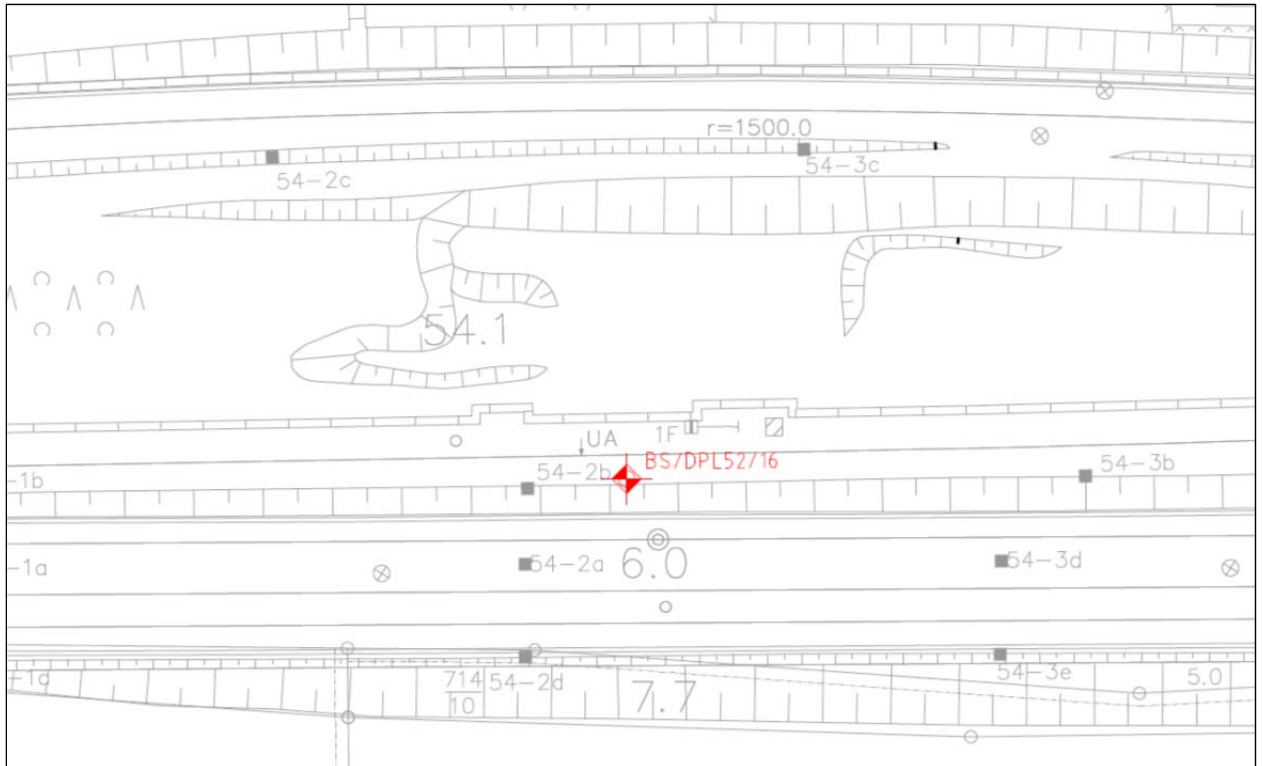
Ausschnitt aus dem IVL Plan mit Lage der BS + DPH52/16
